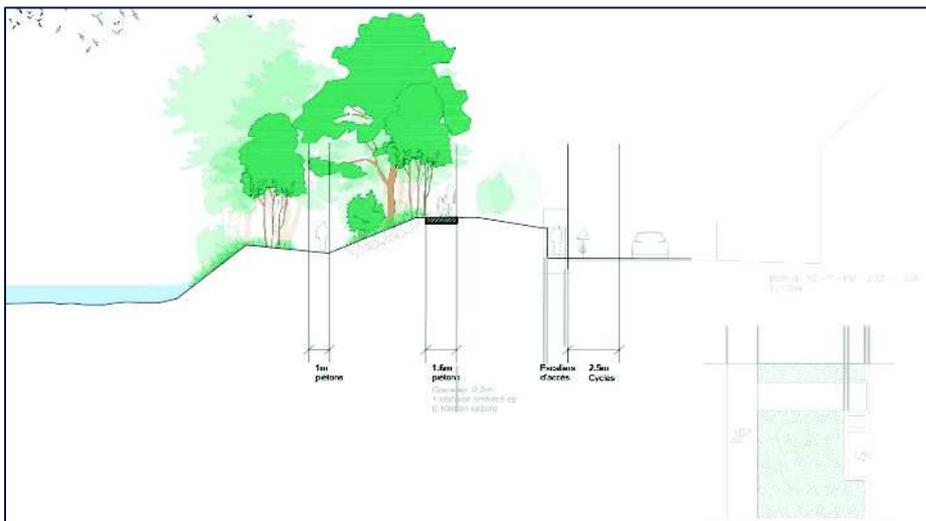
Profil type RD-T1 et vue en plan des escaliers d'accès
